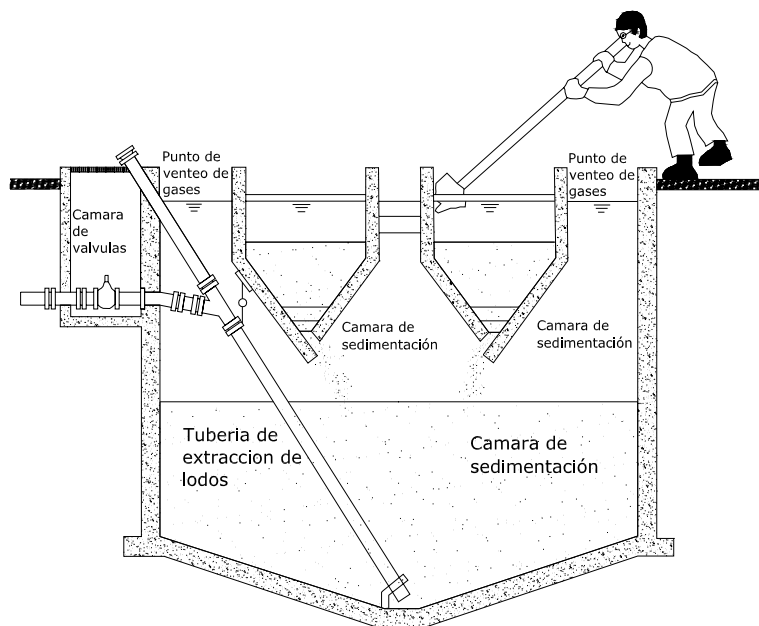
Operador limpiando las paredes de la cámara de sedimentación de un tanque Imhoff
